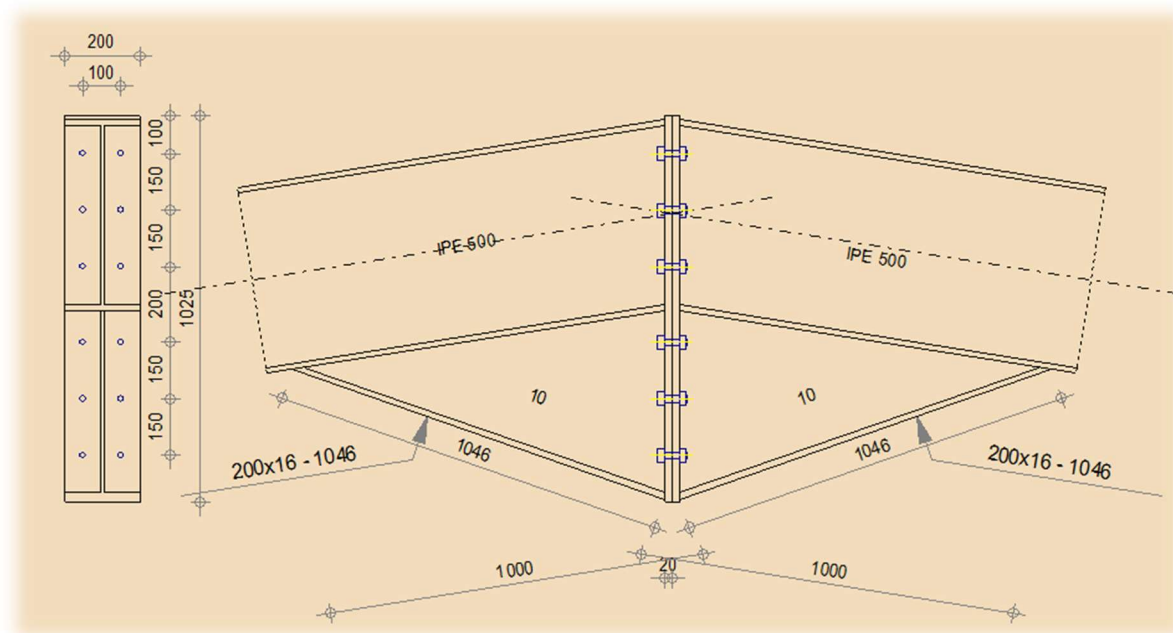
Détail d’assemblage poteau - traverse (IPE500-IPE500)
